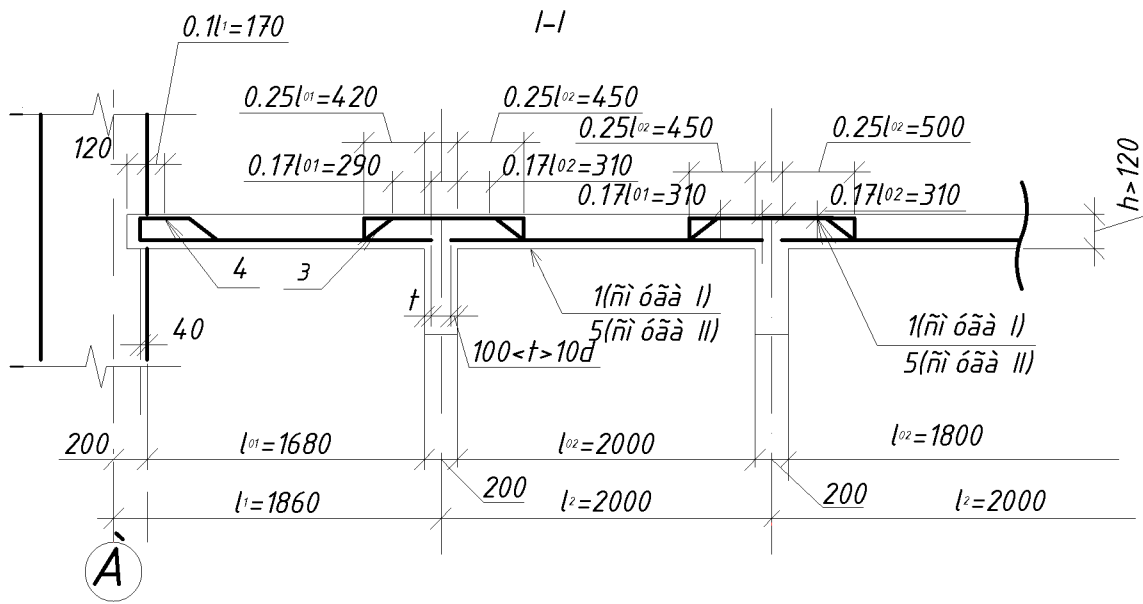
Армування плити в'язаними сітками (окремими стержнями) з відгинами
